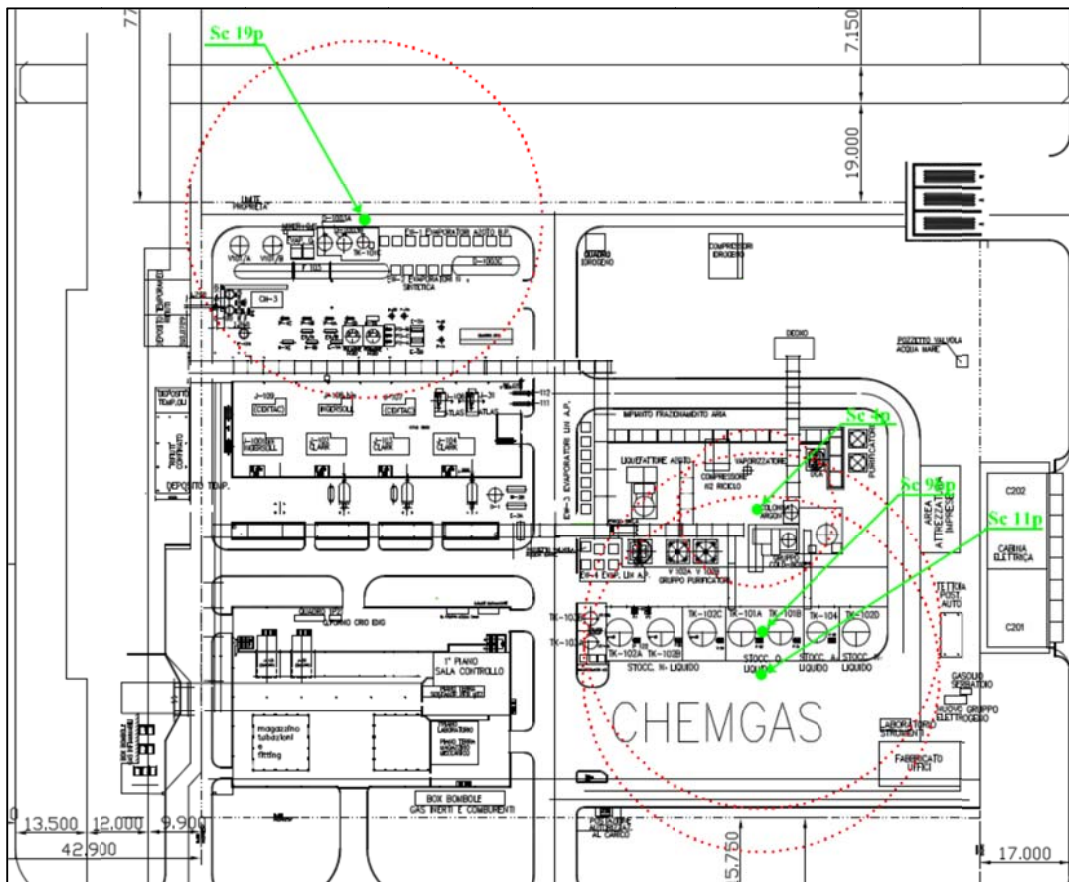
Stralcio della Planimetria limiti proprietà impianto - Dispersioni Ossigeno Rottura Parziale F2
